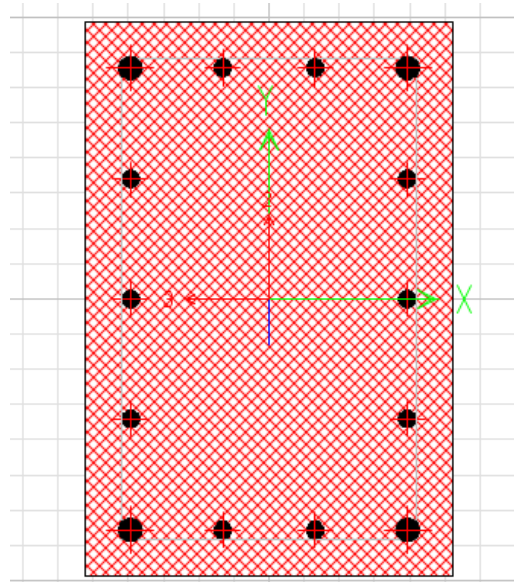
Esquema de columna rectangular planteada en SAP2000.
